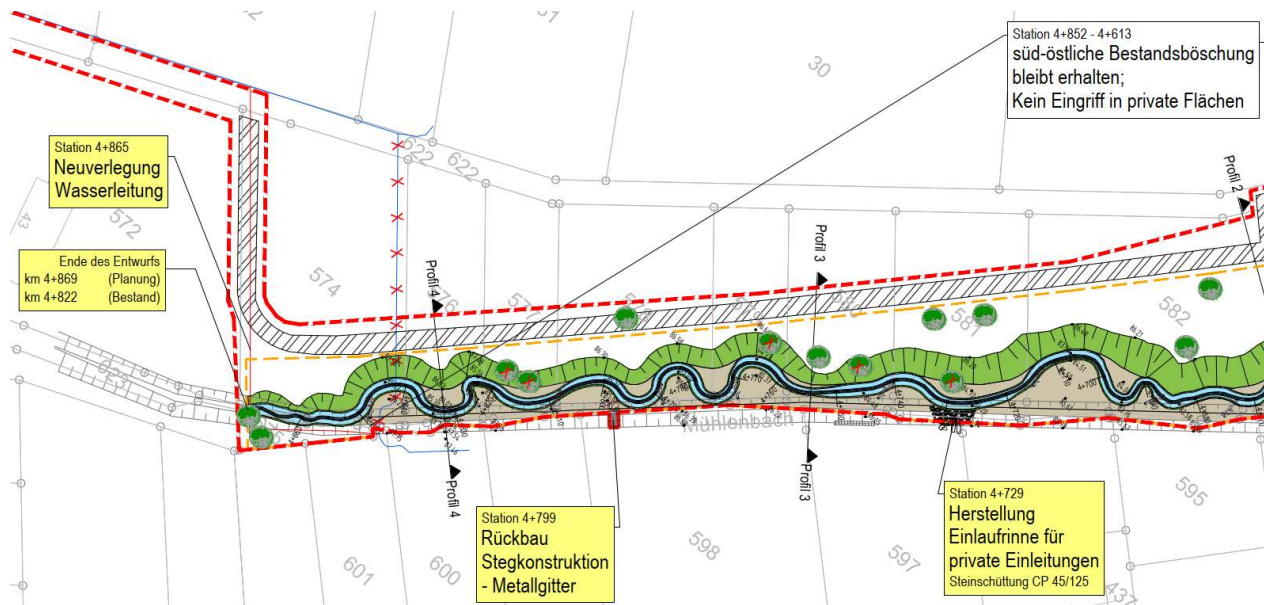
Geplante Maßnahmen zum Abschnitt 1 (Lageplan – Blatt-Nr. 03)
